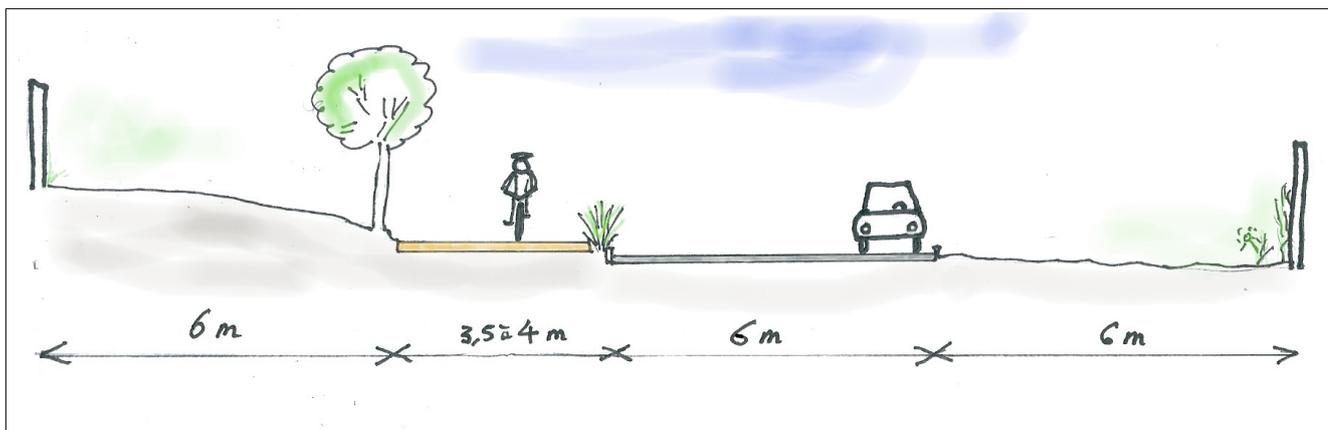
b: Voie Douce installée en site propre sur le trottoir de la Grande Rue, dans les premiers 150 mètres
